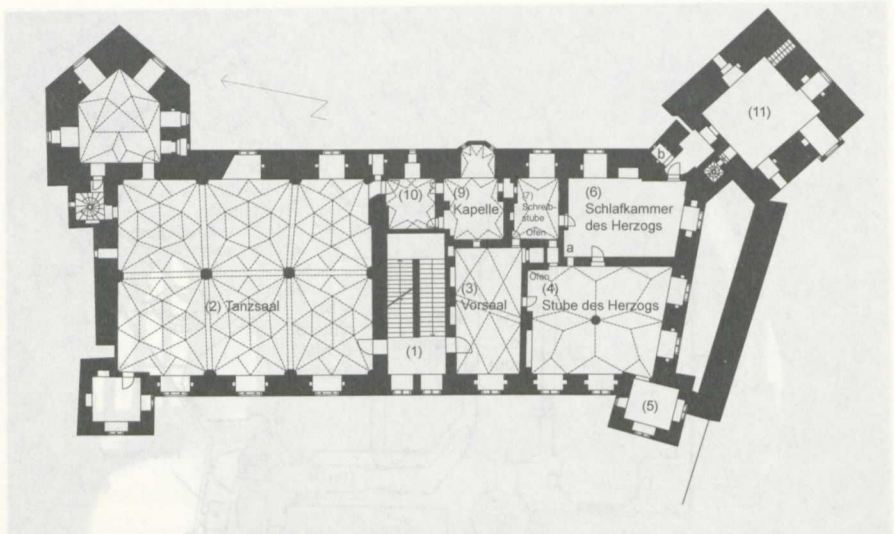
Ingolstadt, Neues Schloss 1479 – um 1489, Grundriss des ersten Obergeschosses des Palas, nach einer Bauaufnahme des Staatlichen Bauamtes Ingolstadt von 2007 mit Ergänzungen Hoppe
